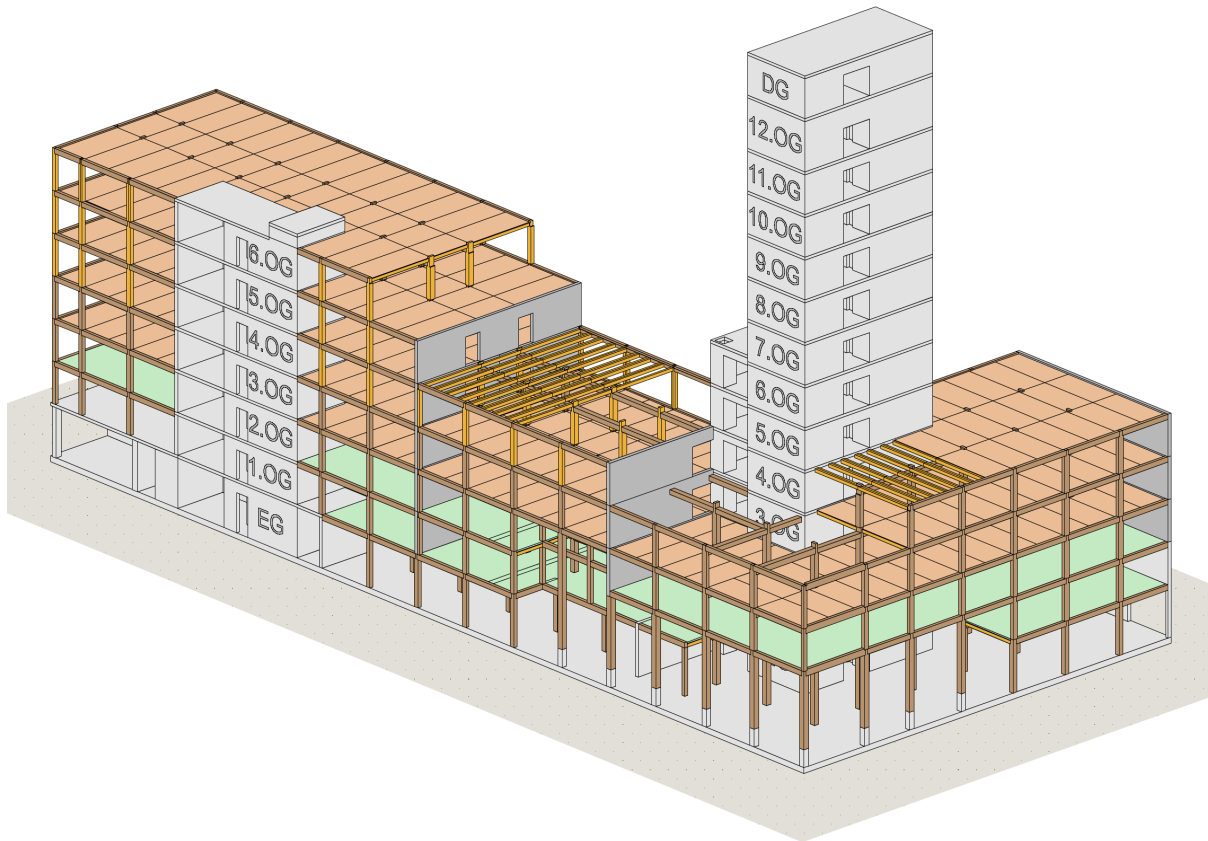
Prinzip der Tragkonstruktion mit aussteifenden Kernen aus Stahlbeton und einer Skelettkonstruktion aus Holz
